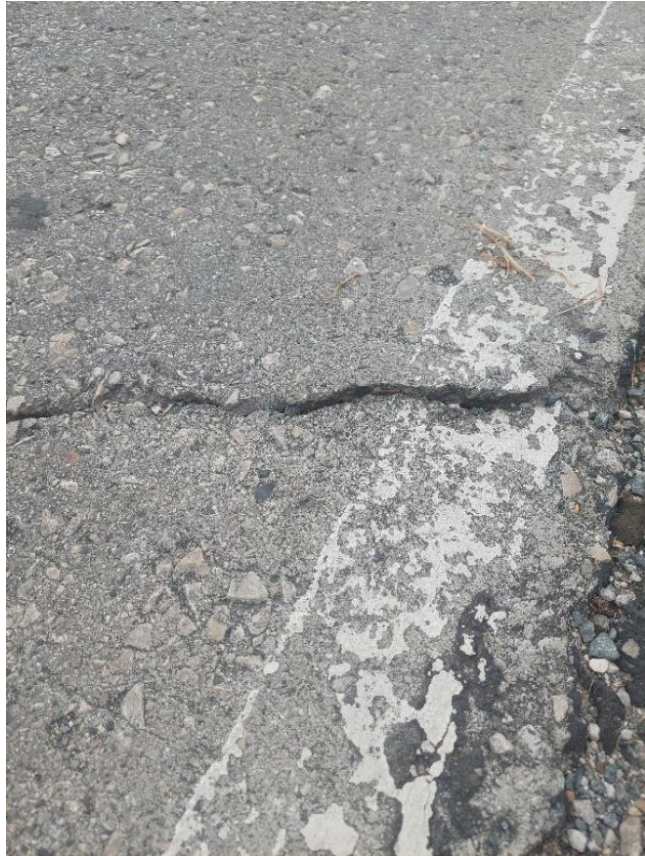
Fisura transversal de severidad baja (abscisa 1+163)
